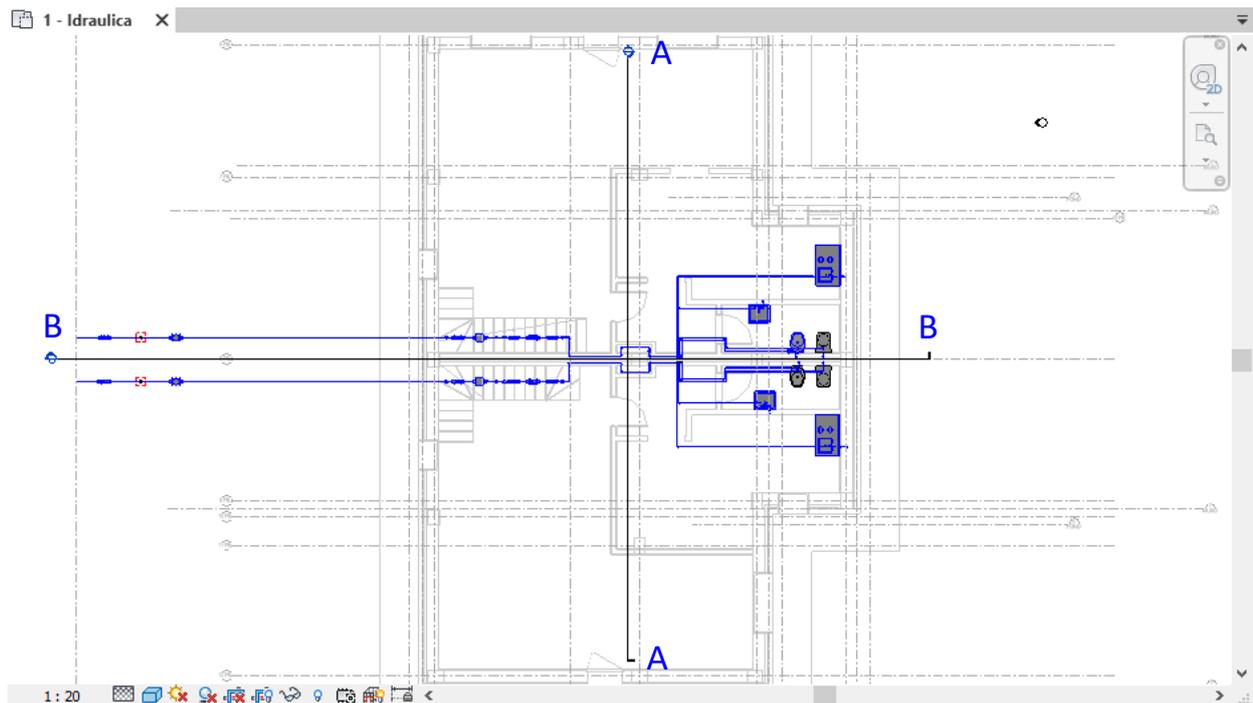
Vista 1- Idraulica: Pianta piano terra
